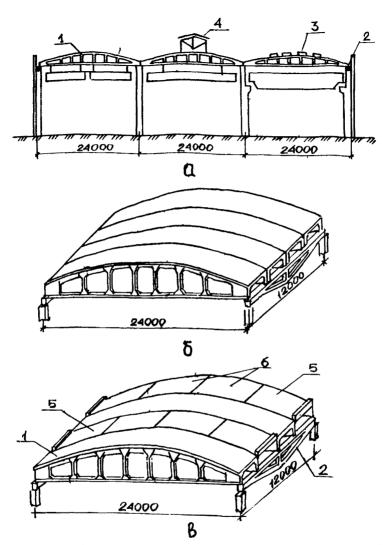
Конструкции покрытий из панелей-оболочек КСО и гибких пластин с панелями-сболочками КСО: 6— рядовое покрытие; в— комбинированное покрытие; 1— панель сболочка КСО: 2— подстропильная конструкция; 3— зенитный фонарь; 4— светоа эрационный фонарь; 3— гибкая пластина, крайняя; 6— гибкая пластина, средняя
